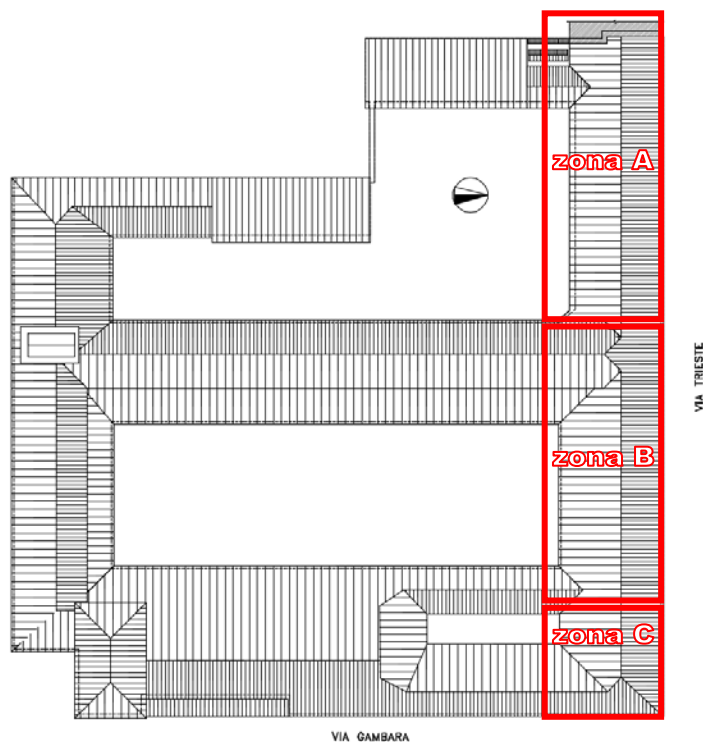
Planimetria con individuazione delle diverse tipologie costruttive tetto prospiciente via Trieste
